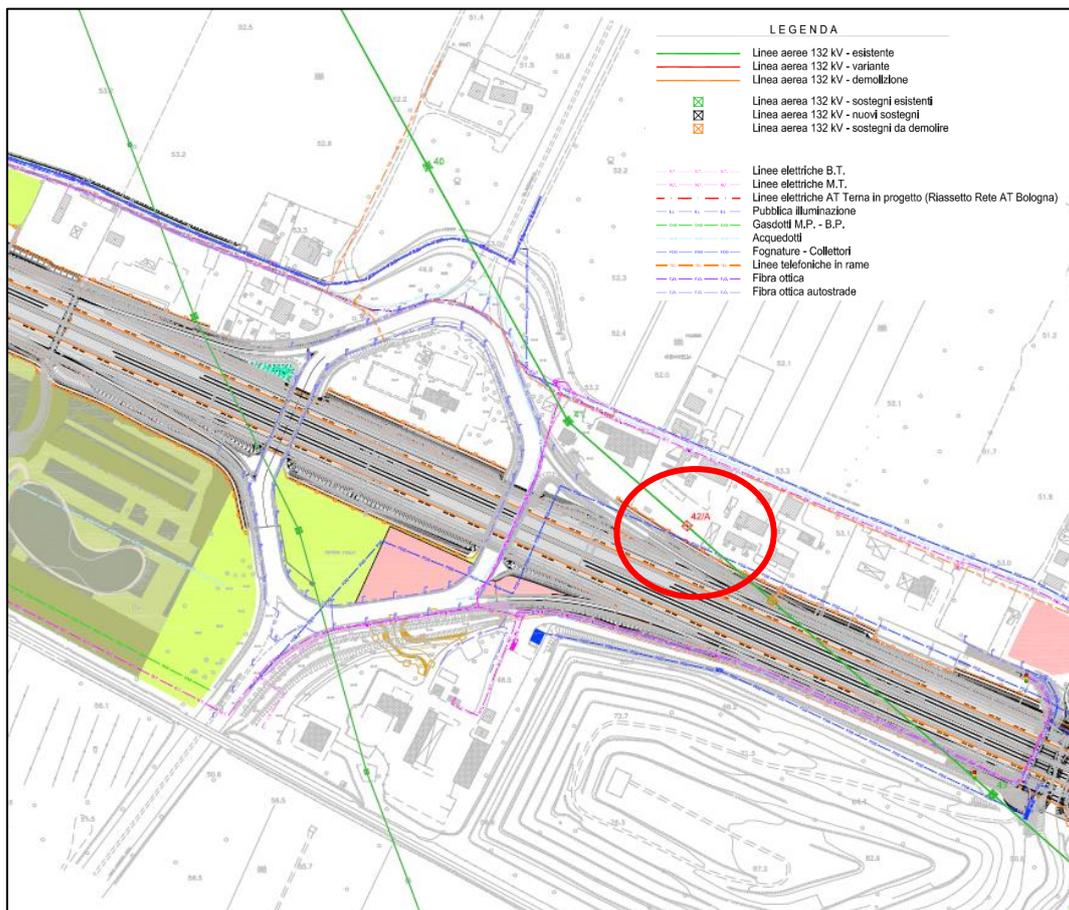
Planimetria di progetto nuovo sostegno 42A.
